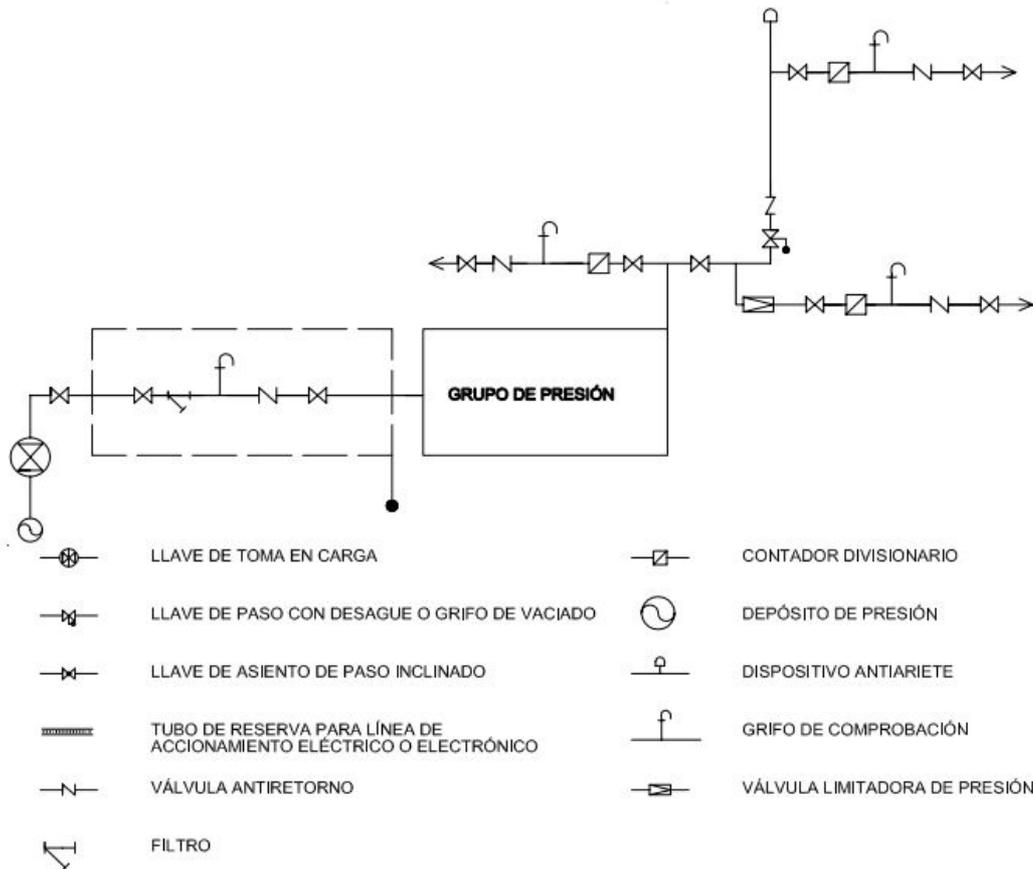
Esquema tipo red de contadores aislados – Fuente: C.T.E. DB-HS4
